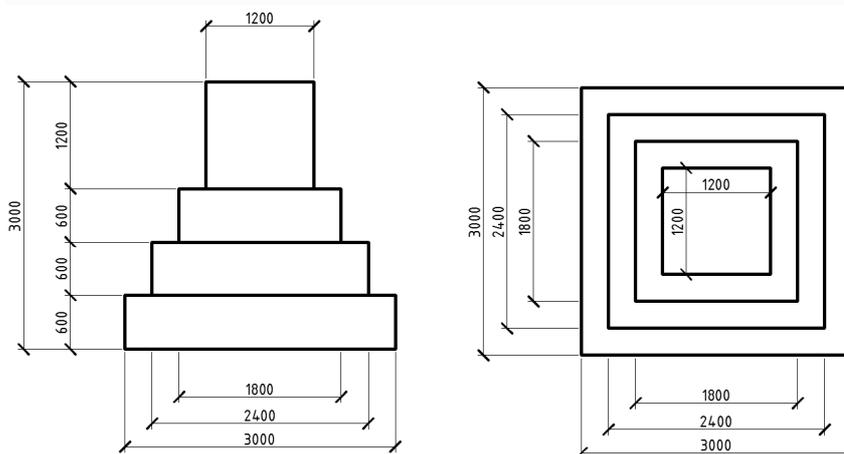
Схемы монолитного фундамента стаканного типа, предназначенного под сборную железобетонную колонну.
